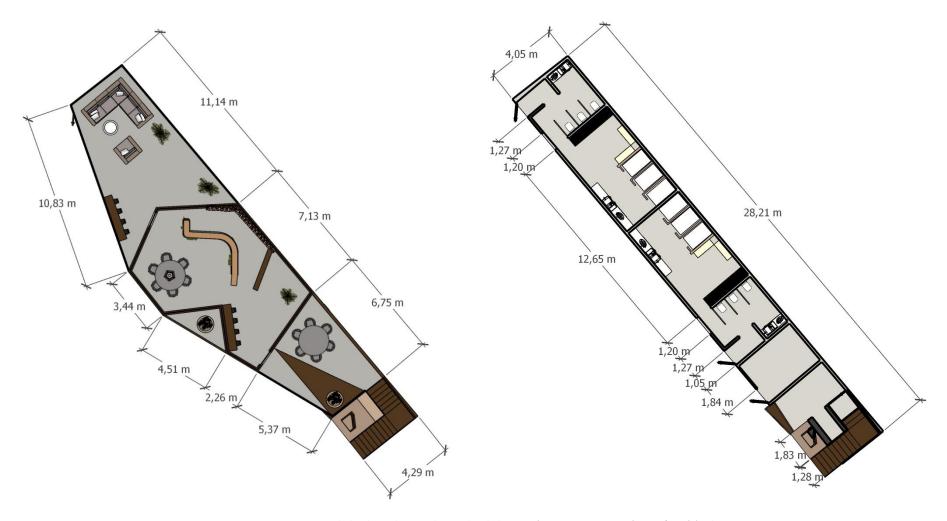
Dimensiones de la planta baja y planta alta de la nave (vestuarios, recepción y cafetería). Plano 2D.
